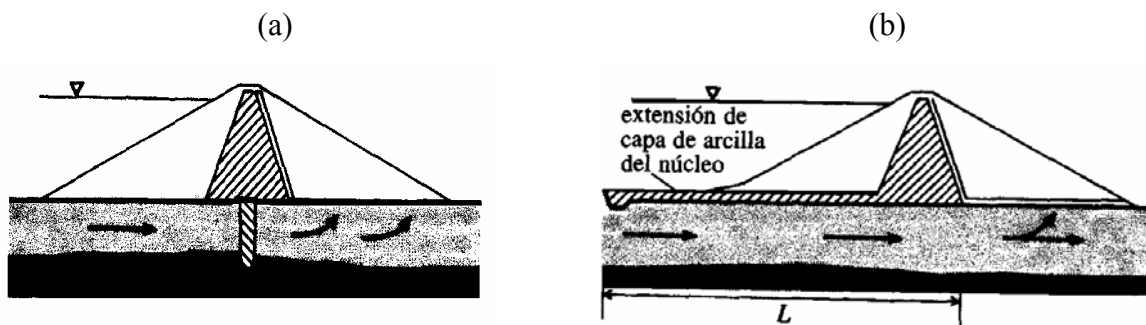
Reducción de la cantidad de infiltración a través de la fundación:
